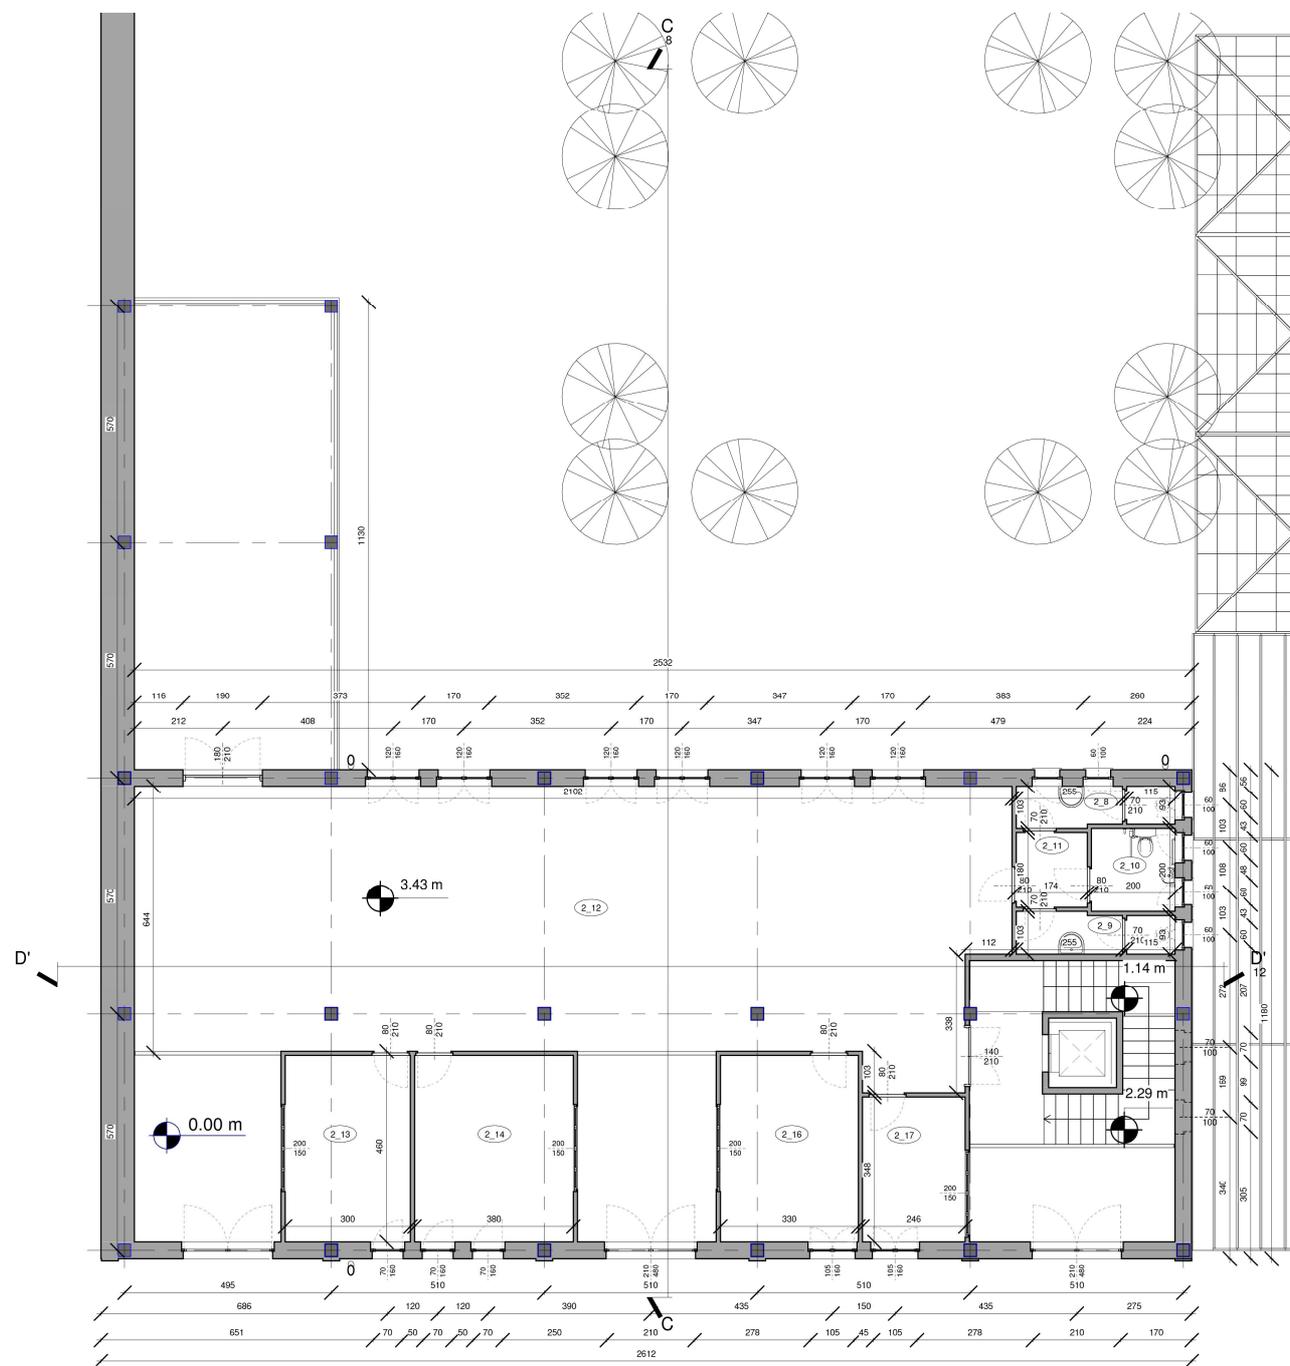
Piano Primo Atelier (Tav. n°7 scala 1:100)
